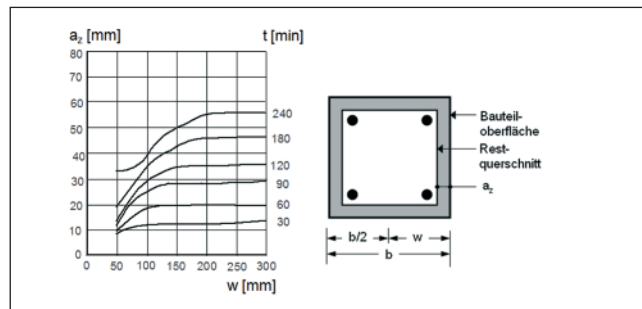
Verkleinerung des Betonquerschnitts von Stützen um das Maß a_z und Restquerschnitt einer vierseitig brandbeanspruchten Stahlbetonstütze
